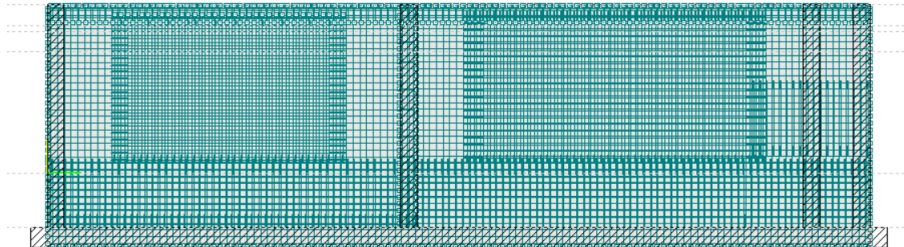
Armatura Parete Perimetrale Lato Esterno
